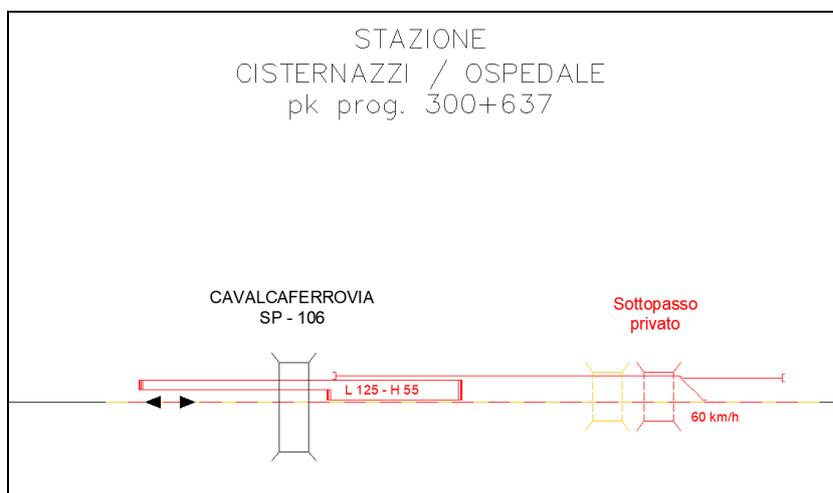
Layout funzionale stazione Cisternazzi/Ospedale
